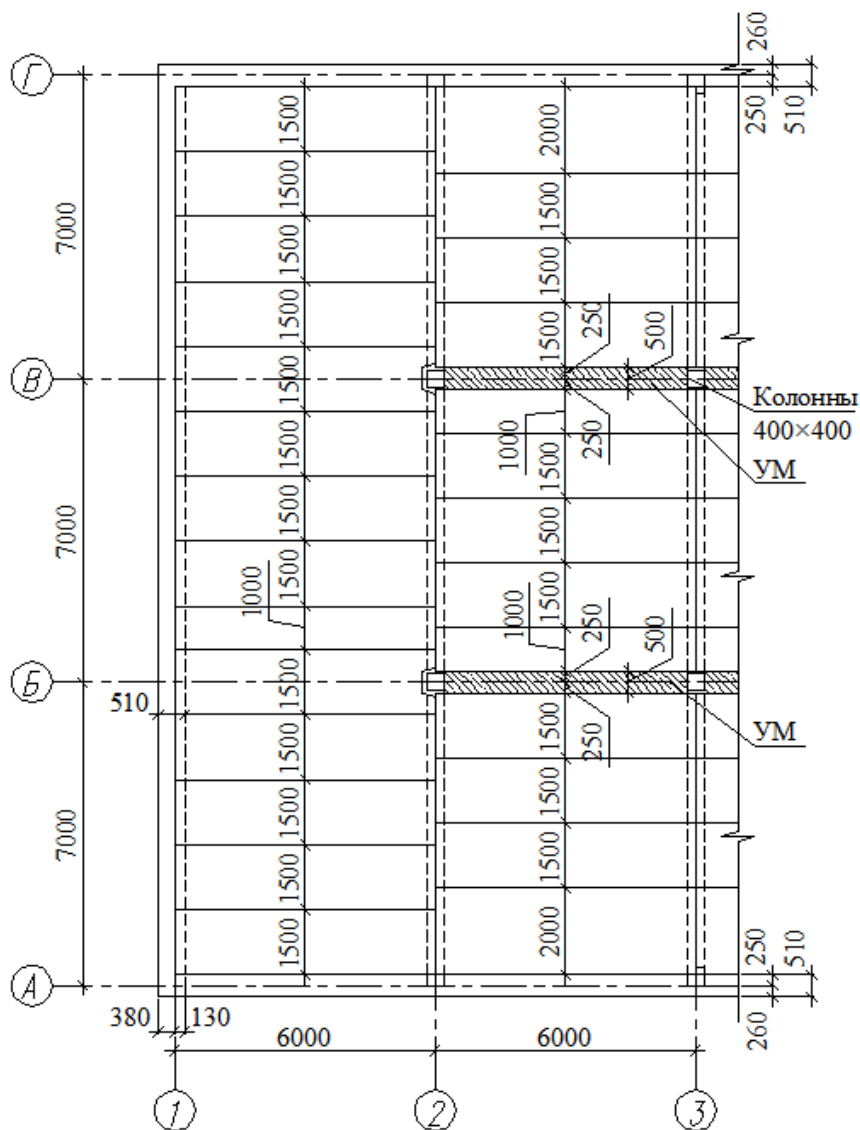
Компоночная схема раскладки плит перекрытий с поперечным расположением ригелей
